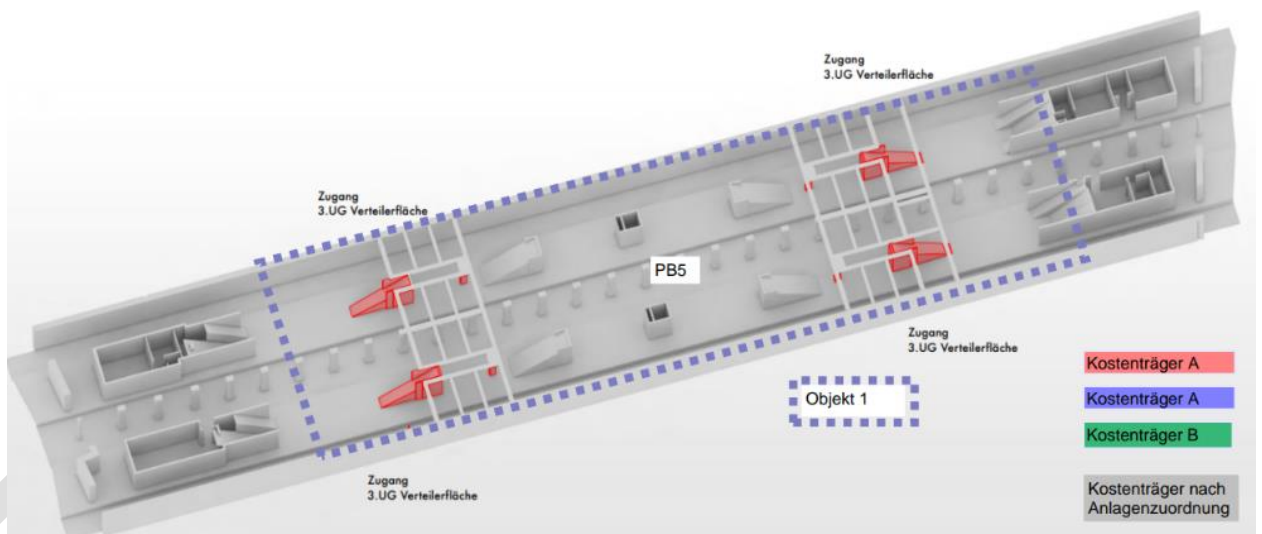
Einteilung Planungsbereiche – 4. Untergeschoss
